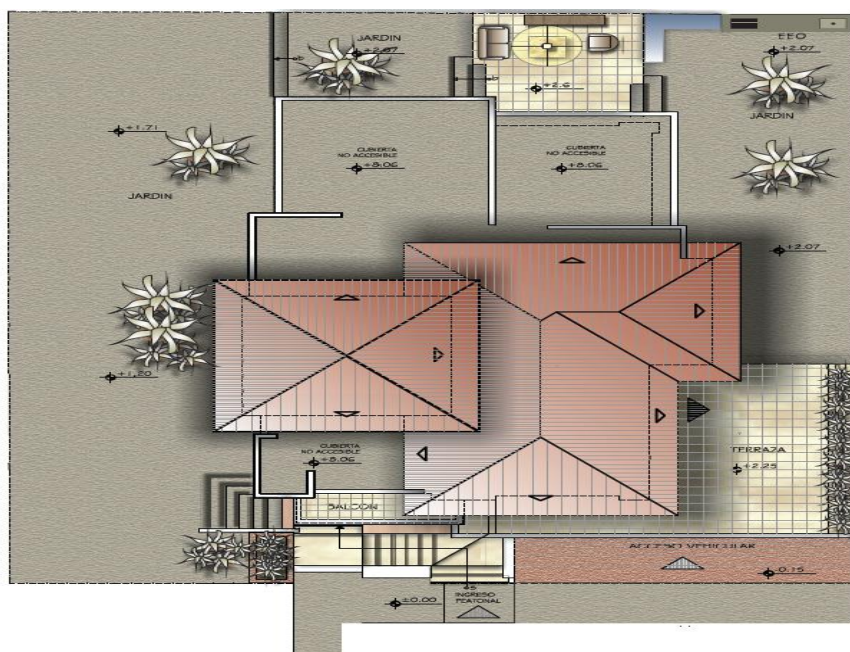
Planos Arquitectónicos Remiresidencia 1
